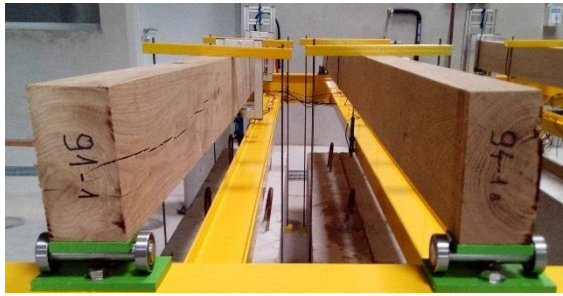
Mise en évidence des fissures non traversantes sur la poutre de chêne C1 (91-1) le jour du chargement, en comparaison à la poutre C2 (94-1)
